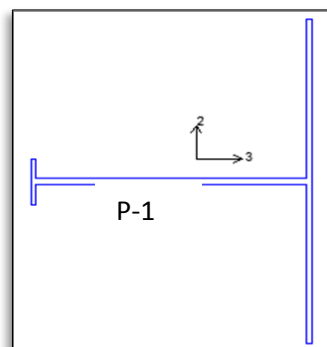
Planta típica con nomenclatura de los muros de concreto armado.
